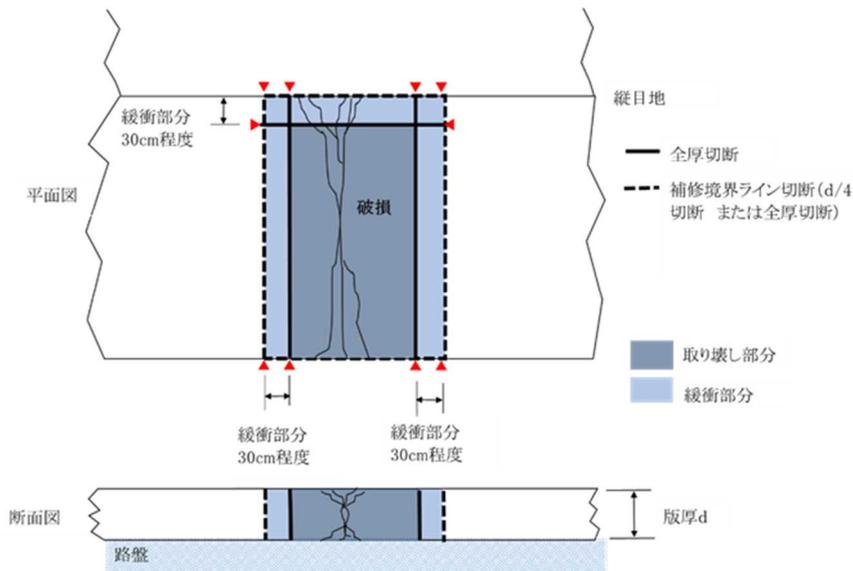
補修範囲（連続鉄筋コンクリート舗装の例）
